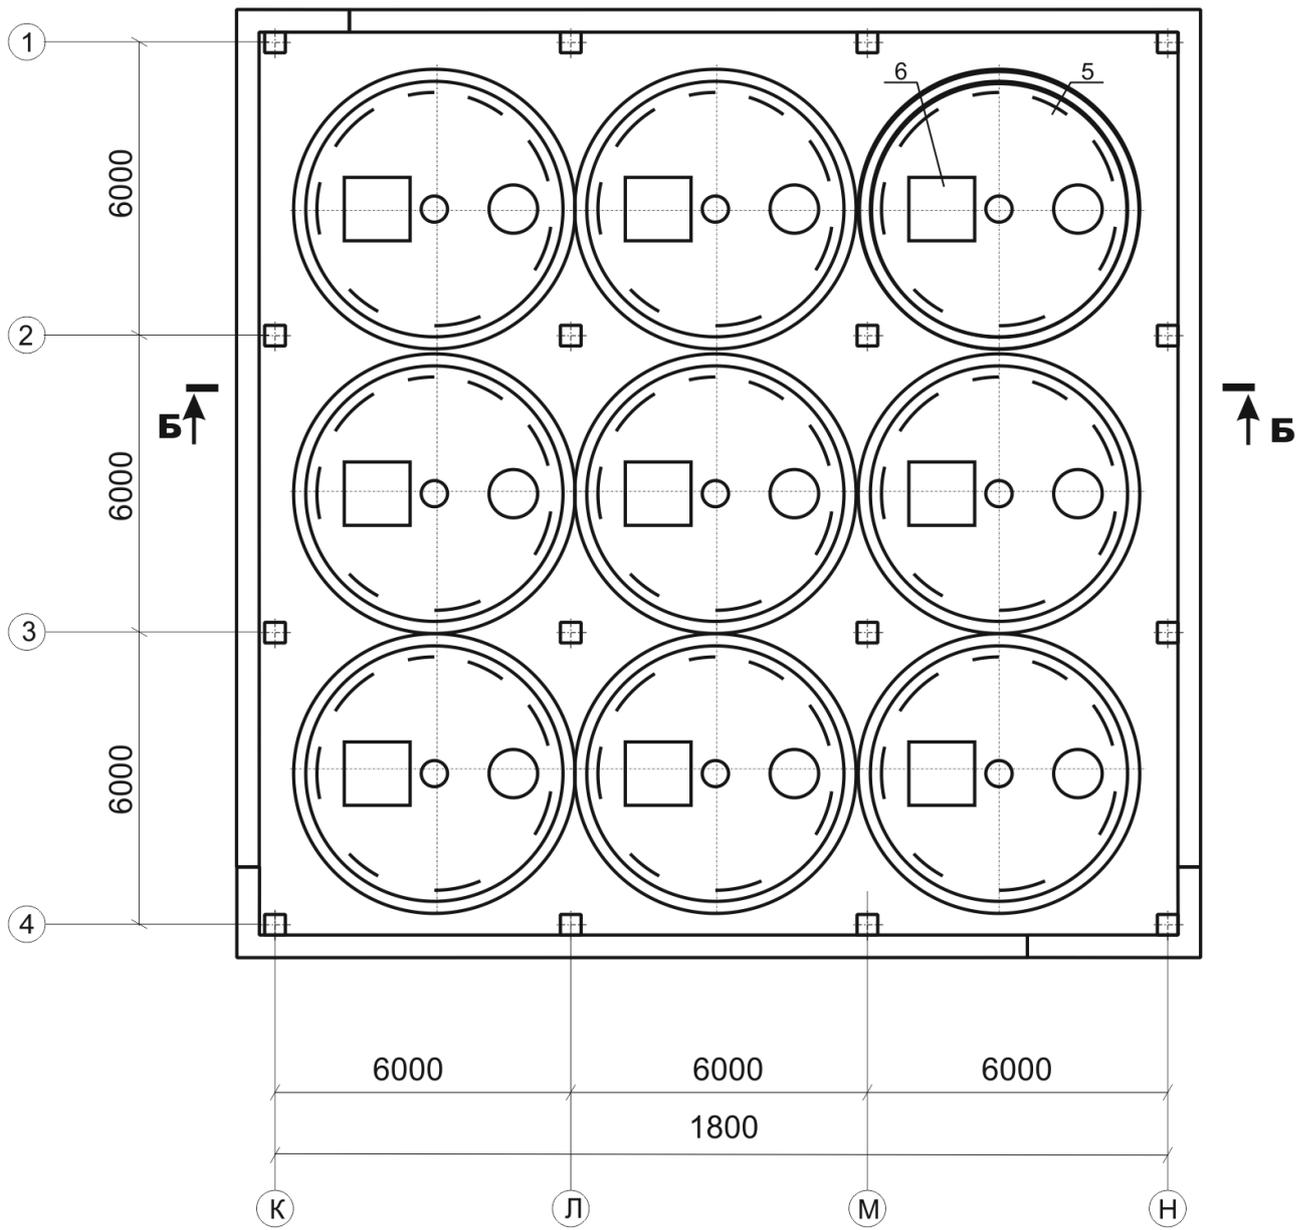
План третьего этажа с компоновкой оборудования [2]
